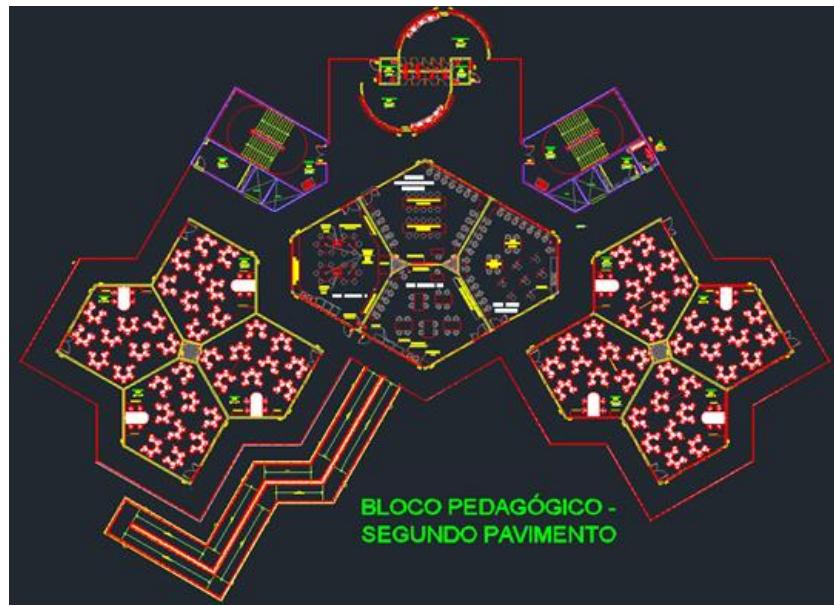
Planta Baixa do 2º pavimento do Núcleo Pedagógico CJA UFSB.
